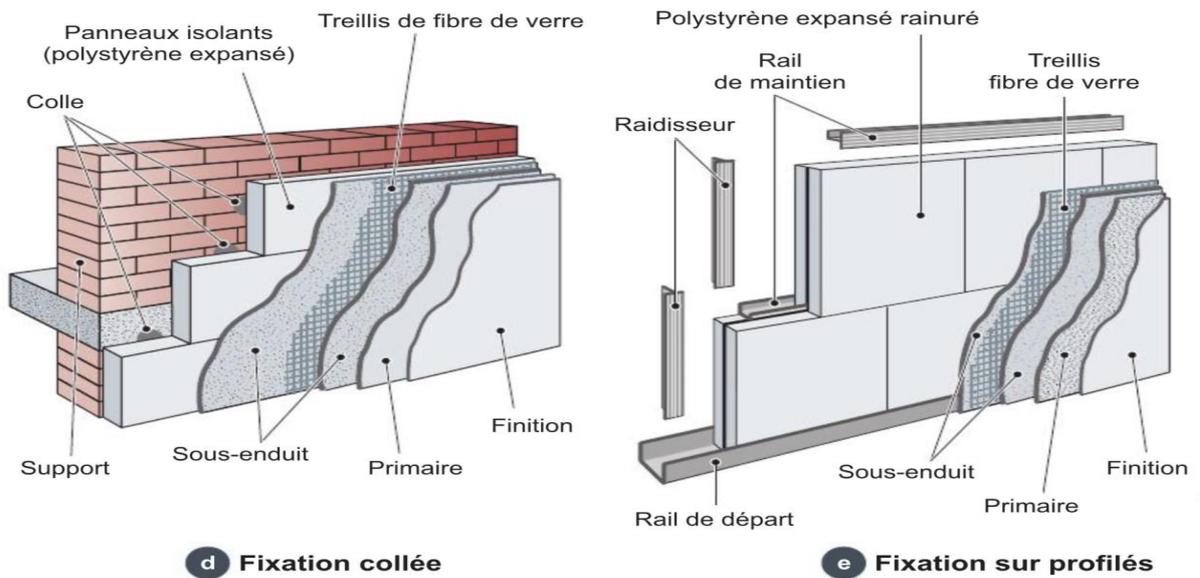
Système d'isolation par enduit sur isolant, par collage et fixation sur profilés [12].
